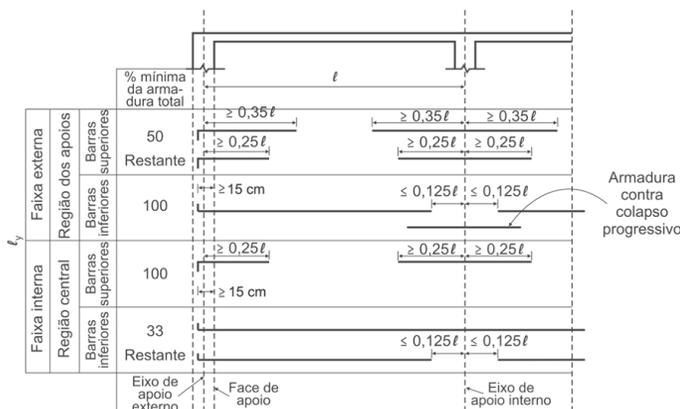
Detalhamento das lajes sem vigas com armaduras passivas calculadas pelo processo aproximado dos pórticos múltiplos. Fonte: ABNT NBR 6118:2003
